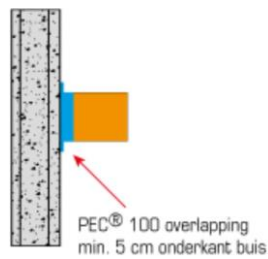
Waterdichting ter hoogte van doorvoeren in betonnen elementen
